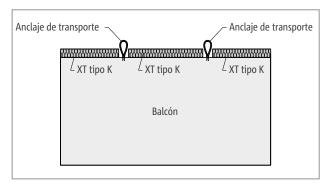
Schöck Isokorb® XT tipo K: Balcón de elementos con anclaje de transporte; in situ se puede colocar el adaptador aislante XT tipo Z
